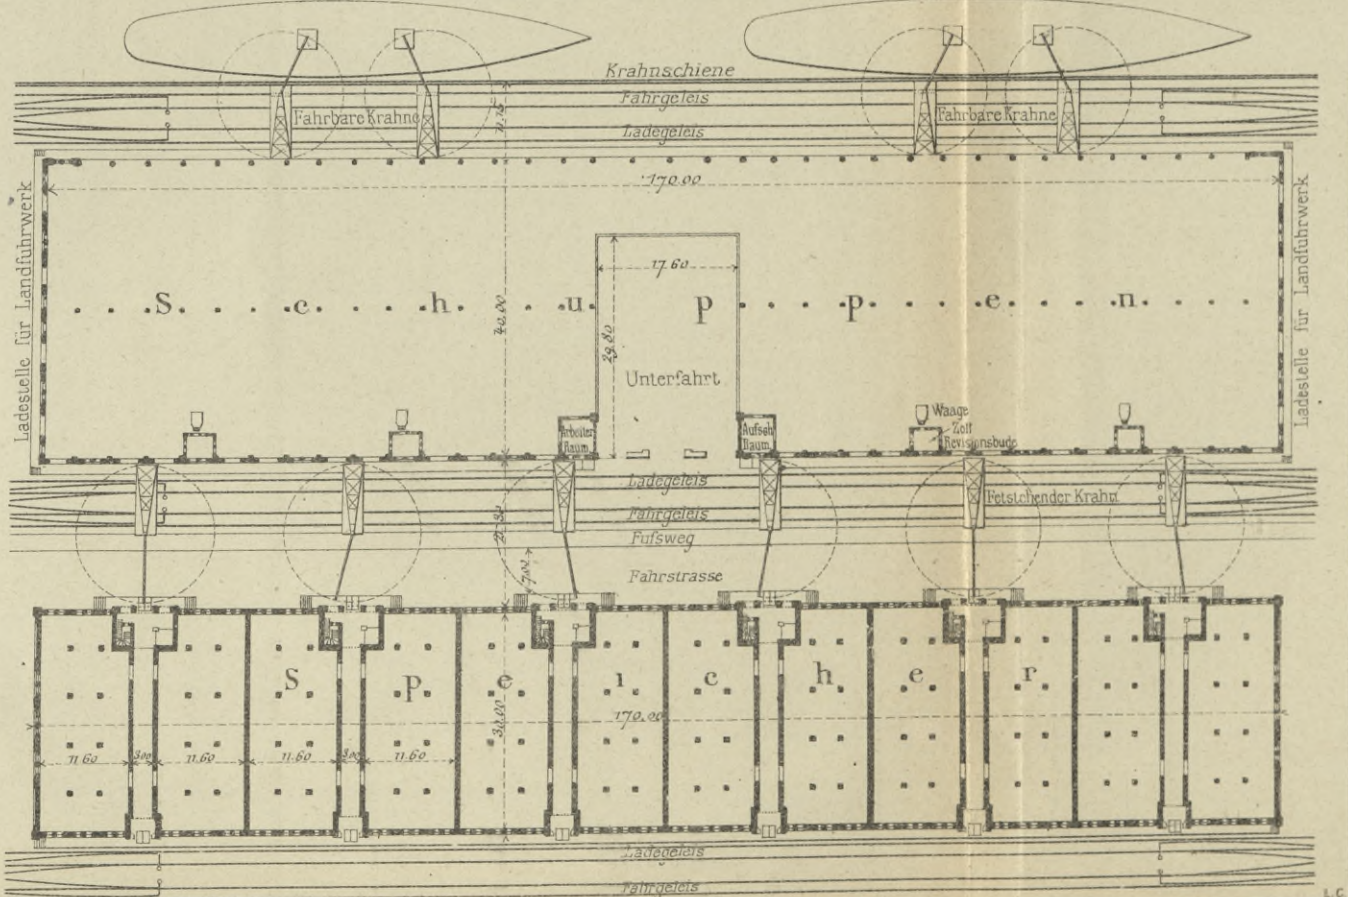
Grundrisse einer Strecke Kai mit Kränen, Gleisen, Schuppen, Speicher u. w. s. — Bremen
